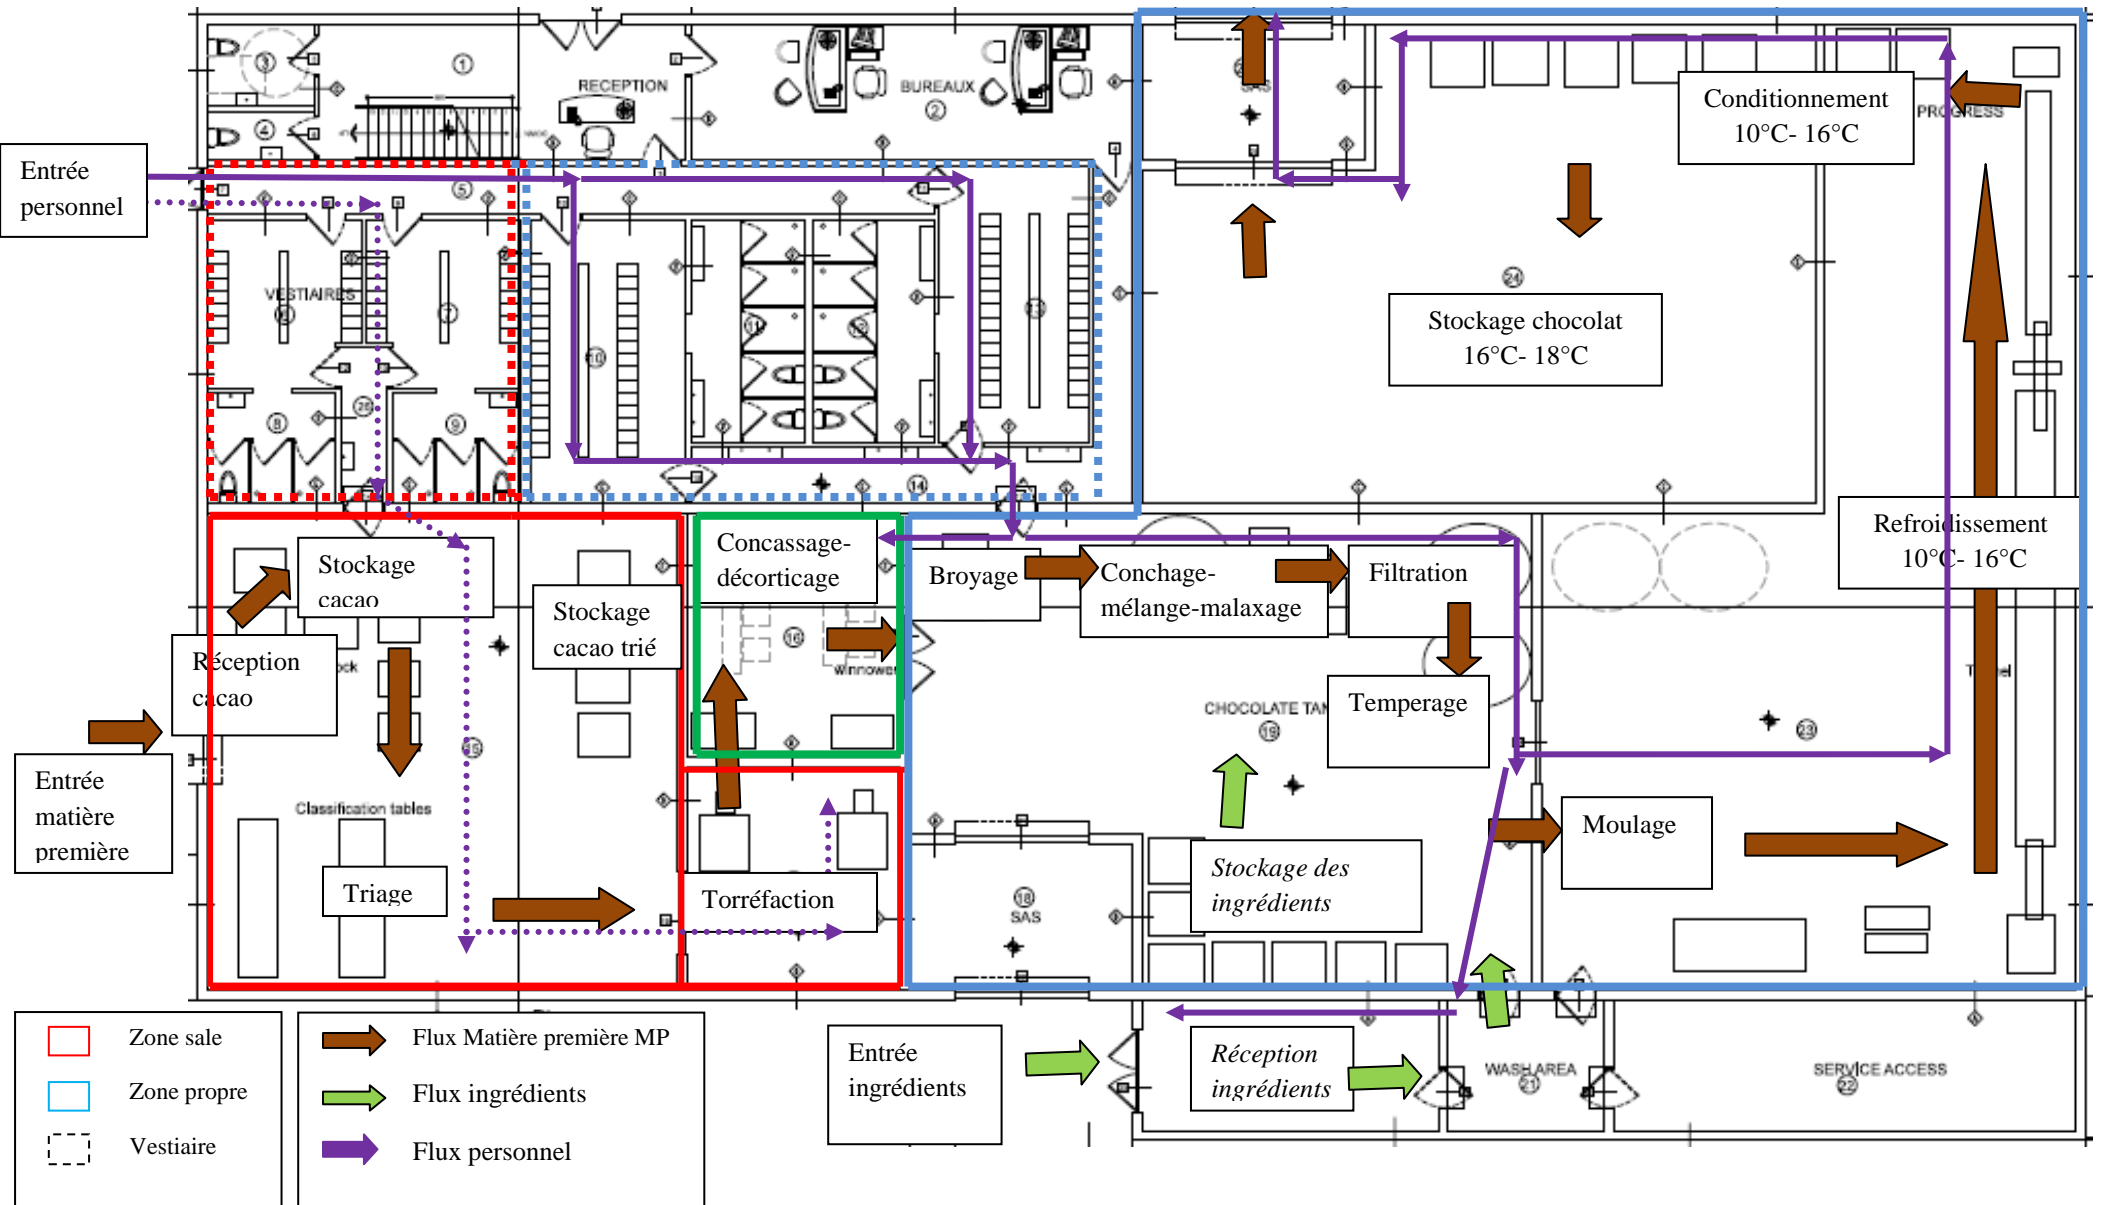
Plan de l'usine et la marche en avant (Source : MADECASSE, 2017)
